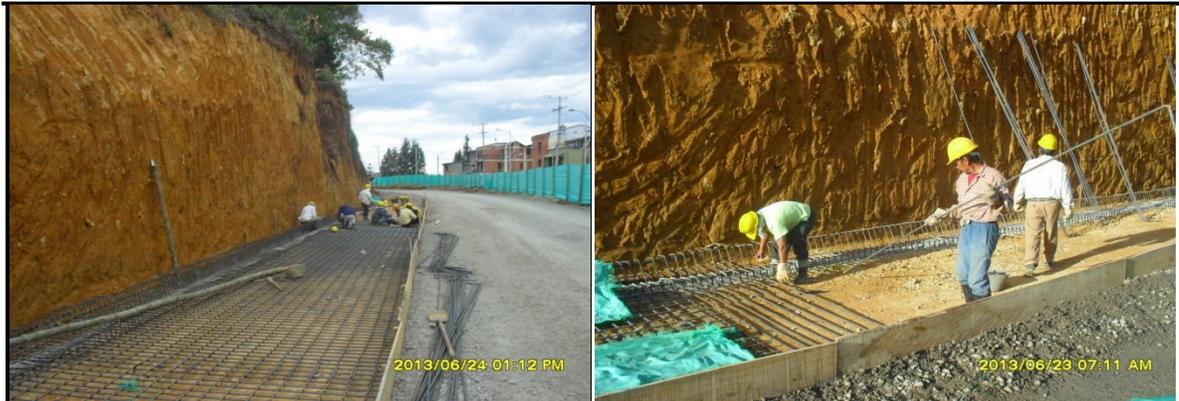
ACERO DE REFUERZO TRANSVERSAL DE LA ZARPA DEL MURO, PARRILLA SUPERIOR.
